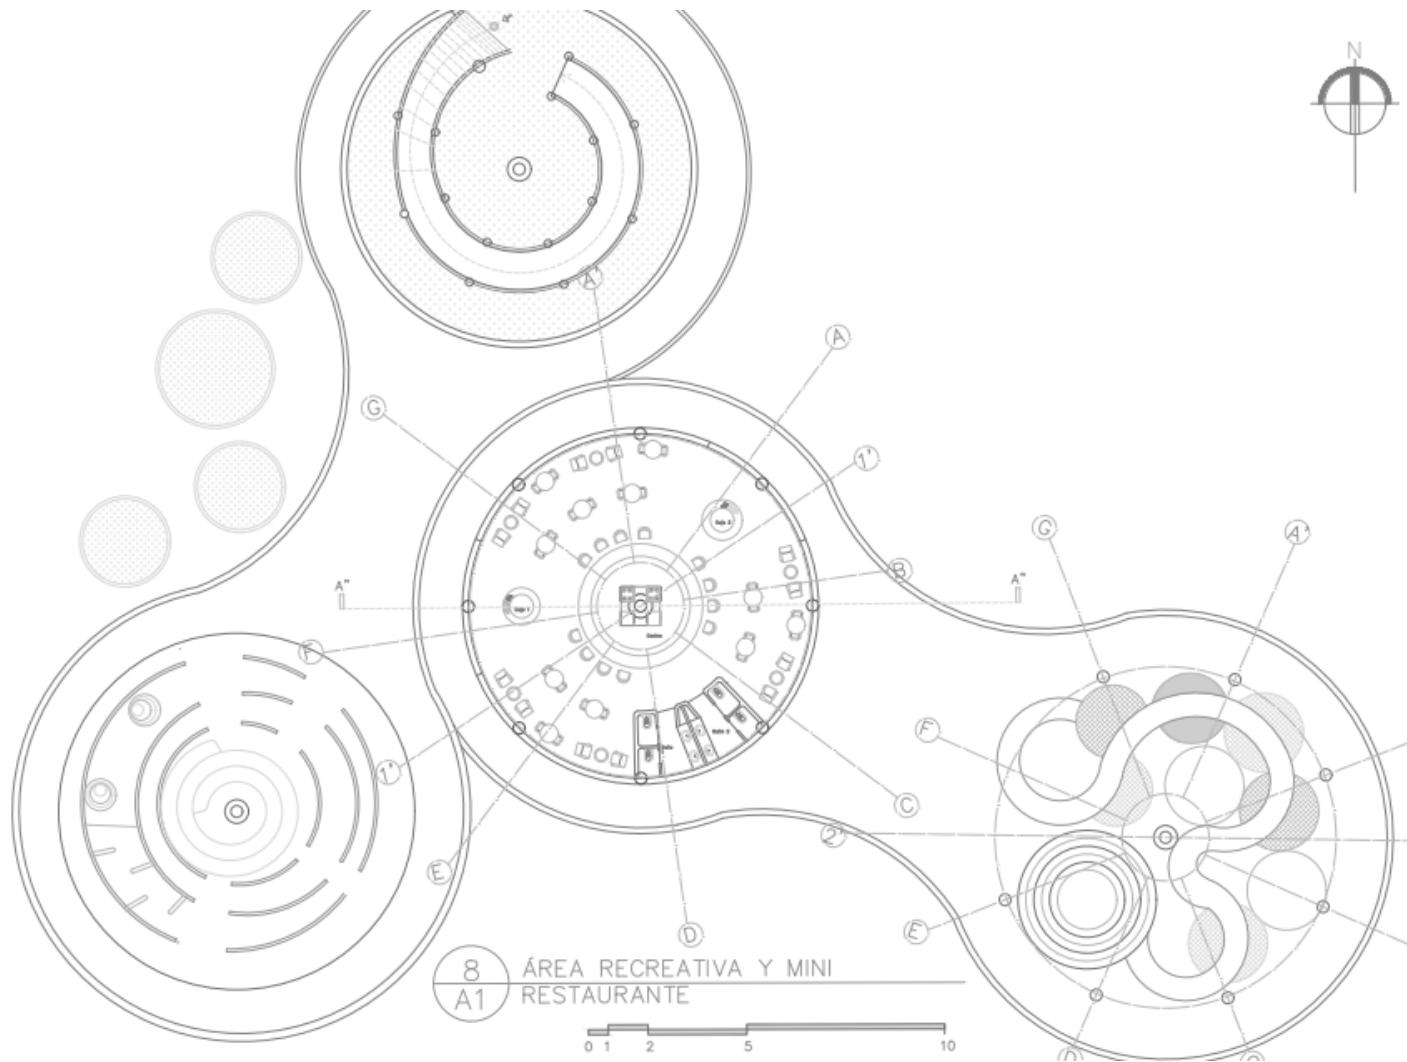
Planta Arquitectónica Zona Recreativa y Área de Mini Restaurante
